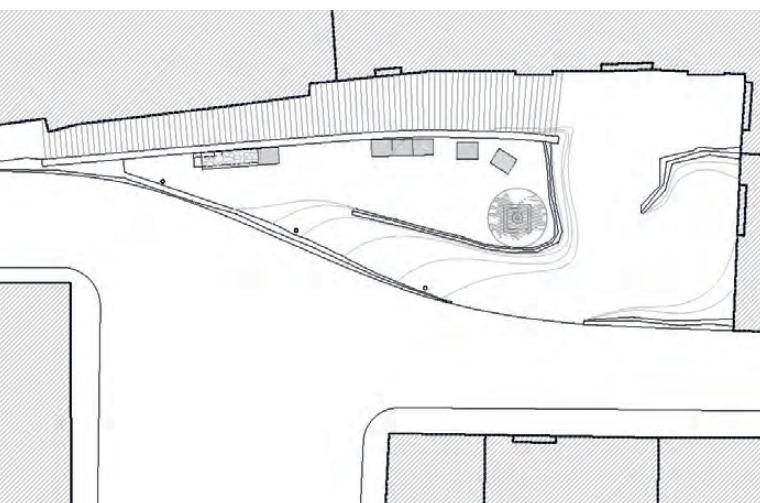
Planta de la propuesta (2000) / Figure 5. General plan of proposal (2000).
